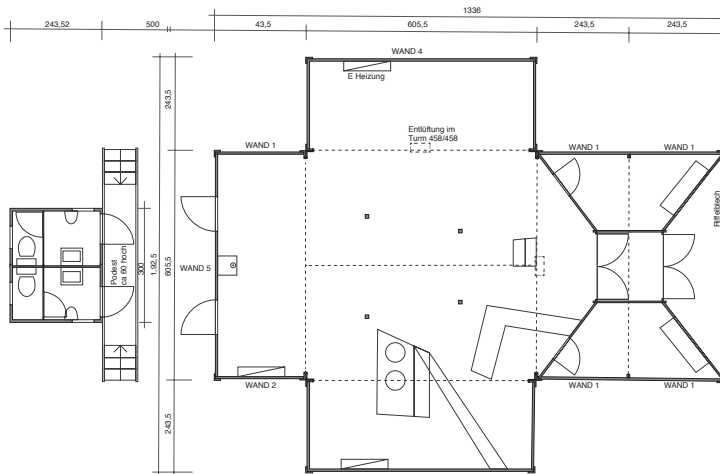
Arch DI Helmut Reitter, 1990: Das Café Paradox, Grundriss
